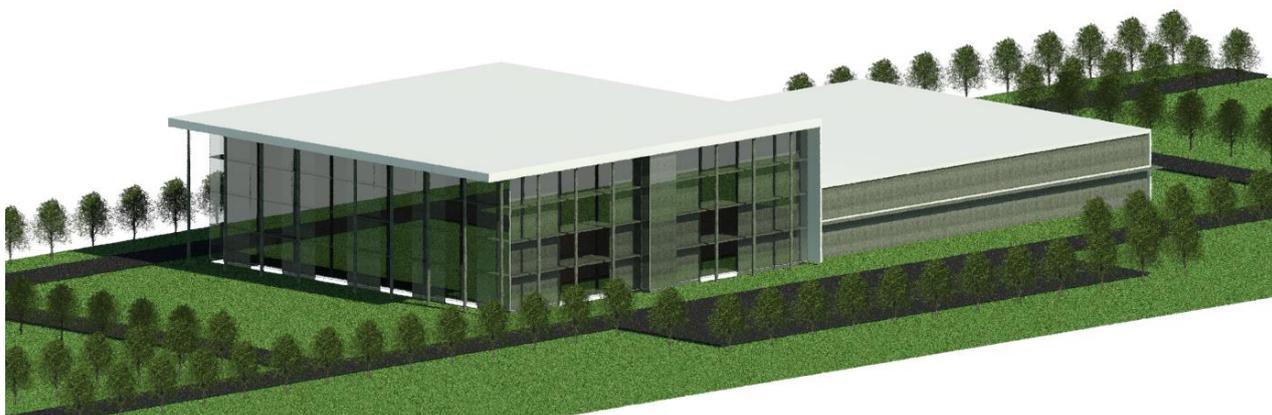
Предварительная схема фасада и его элементов, выполненная в ПК Revit
